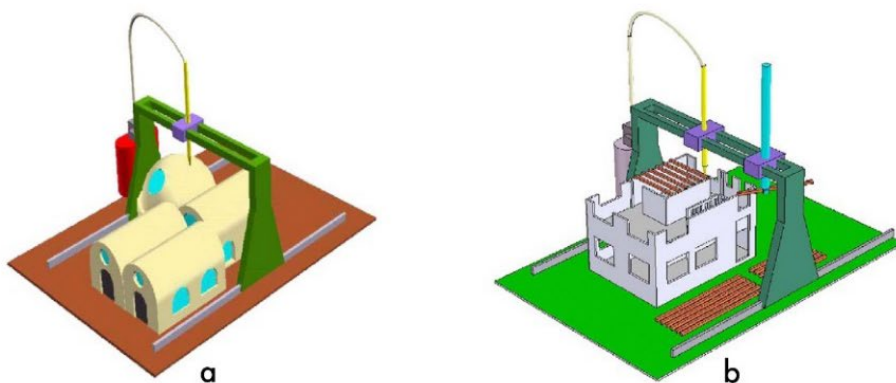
Configuração do pórtico de CC para construções em Adobe (a) e concreto (b).
